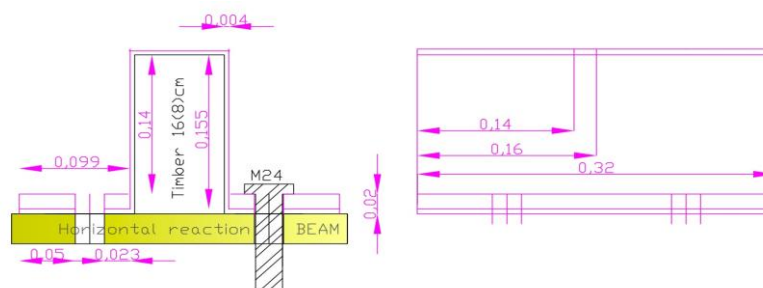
Sistema de ancoragem à viga de reacção horizontal (unidades em metros ou de outra forma especificado).
